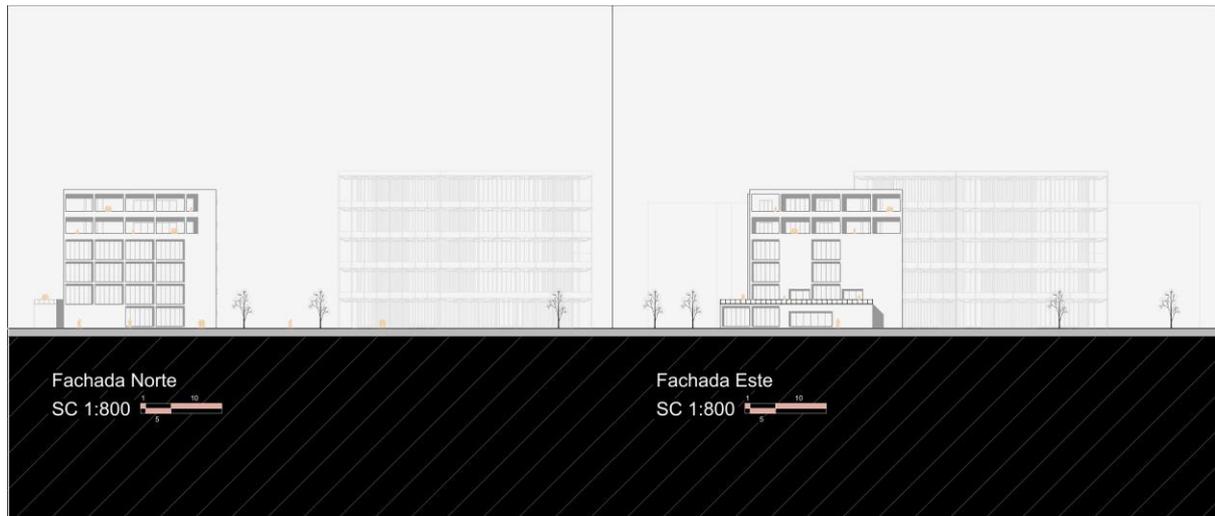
Est. Fachadas Norte & Este. Elaboración Propia
